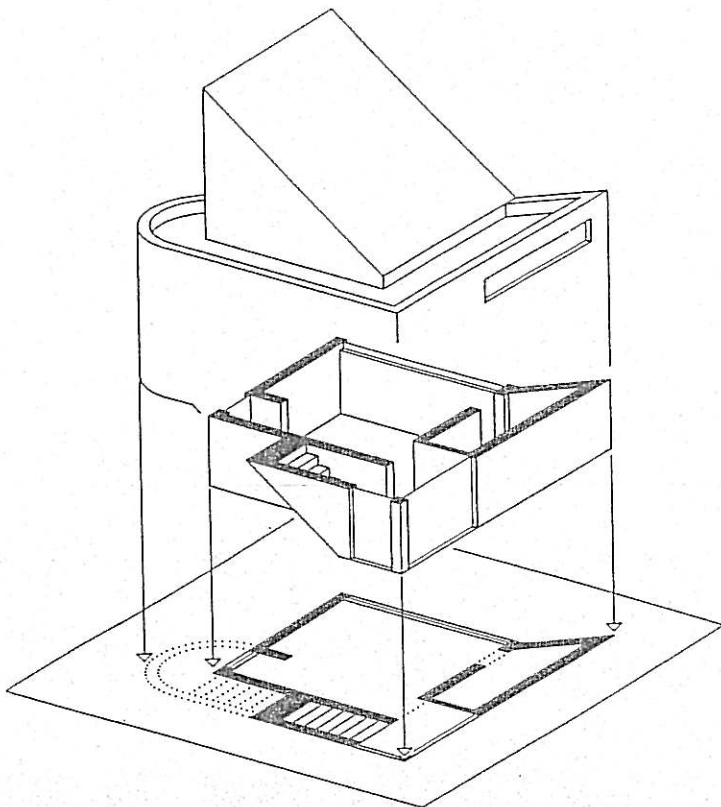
Grundriß Typ A (Abbildungsprinzip)
